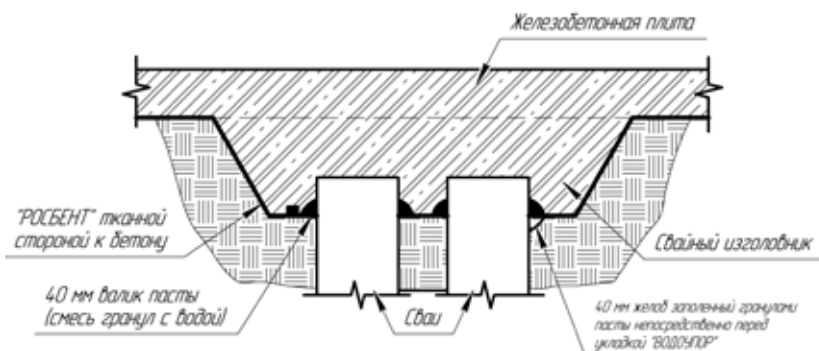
Гидроизоляция подплиточных свай и свайного наголовника.
